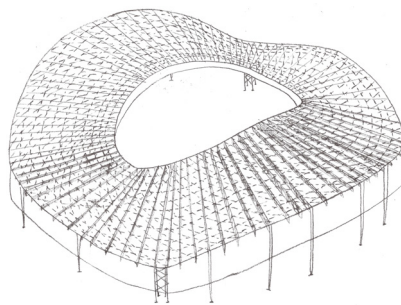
Diagrama del comportamiento estructural de las cubiertas tensadas de la tipología Membrana tridimensional. Elaboración propia.
